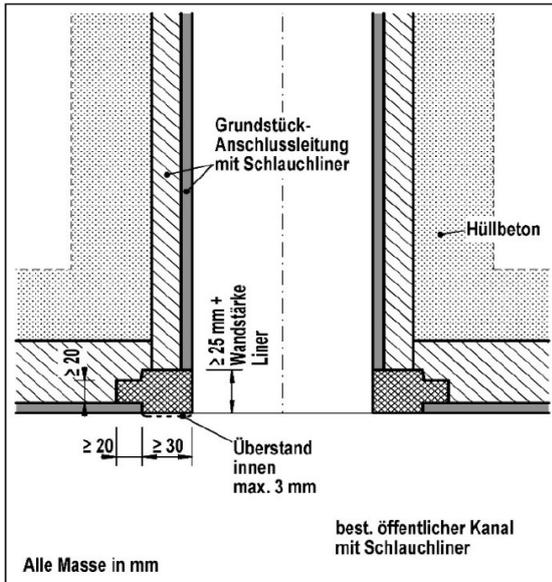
Einbindung des Schlauchliners in einen mit Inliner sanierten öffentlichen Kanal
